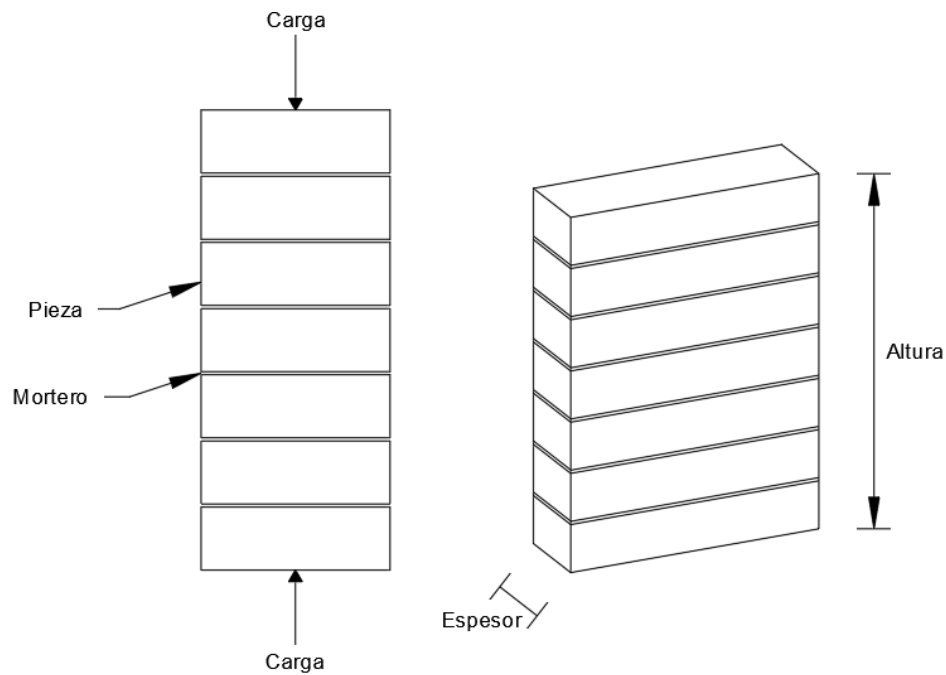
Pila para prueba en compresión (NTC-Mampostería 2020).
